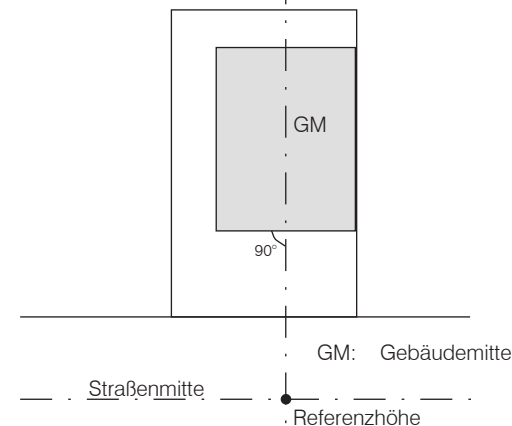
Schema zur Ermittlung des Referenzniveaus (Grundriß)
